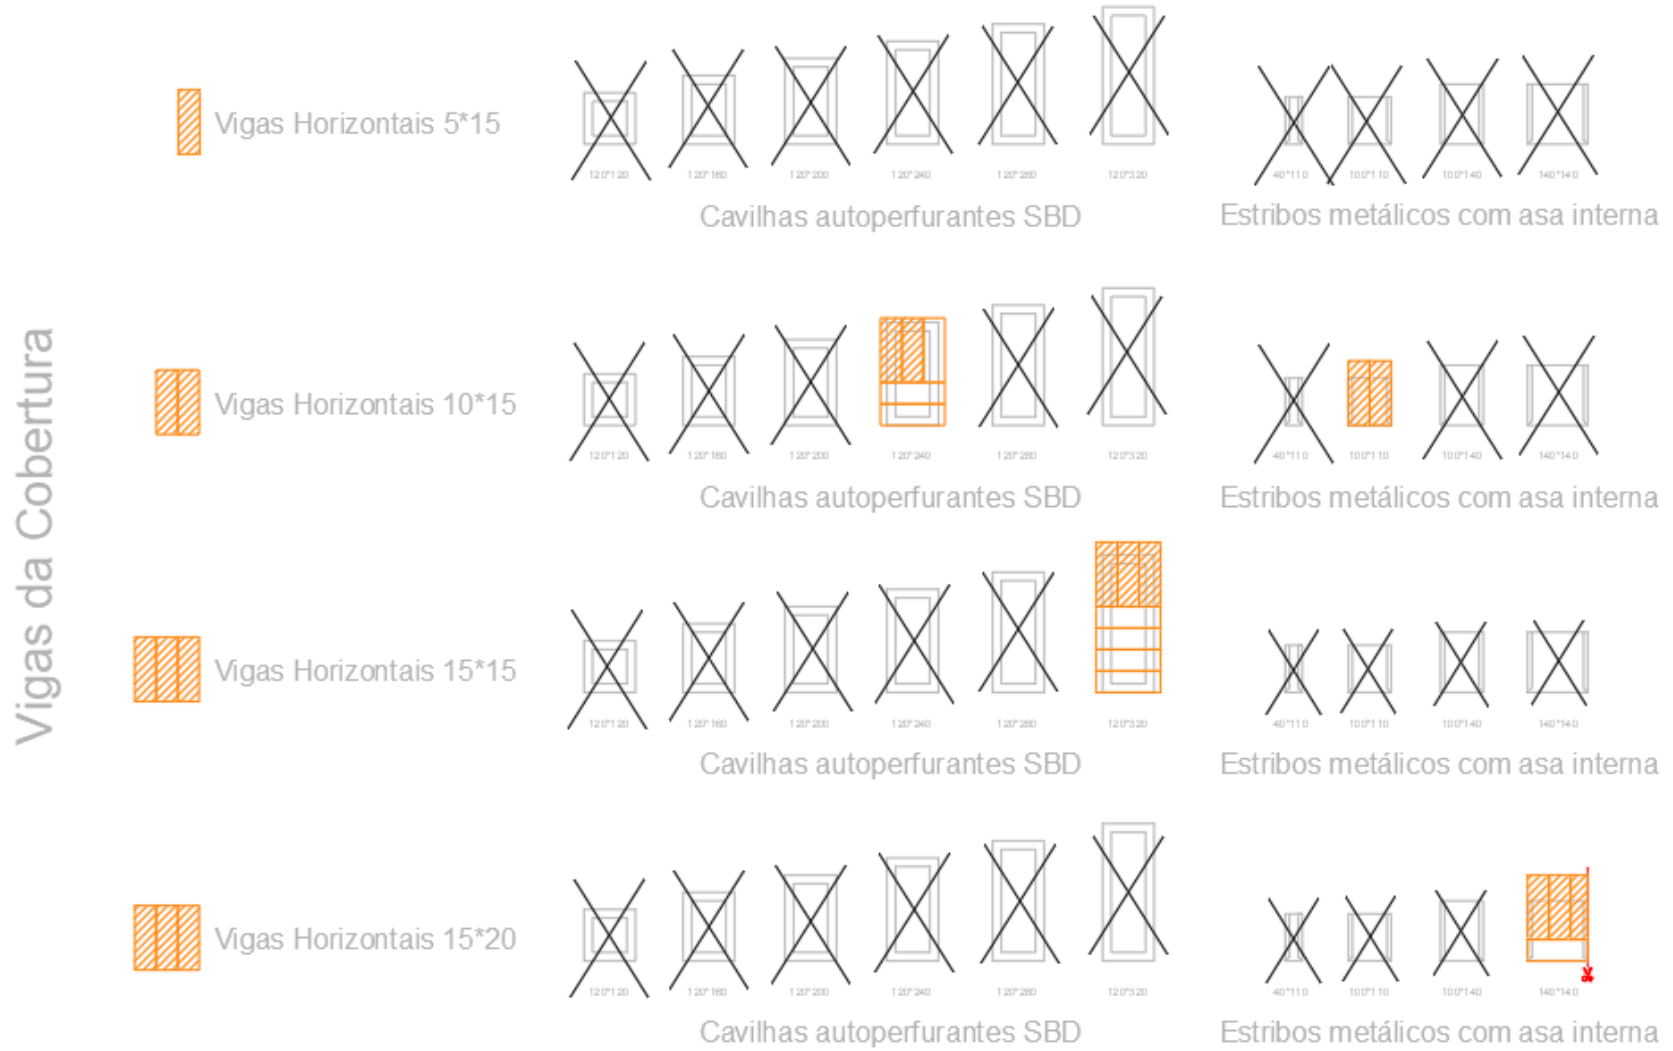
Disposição dos elementos da viga na região da ligação metálica
